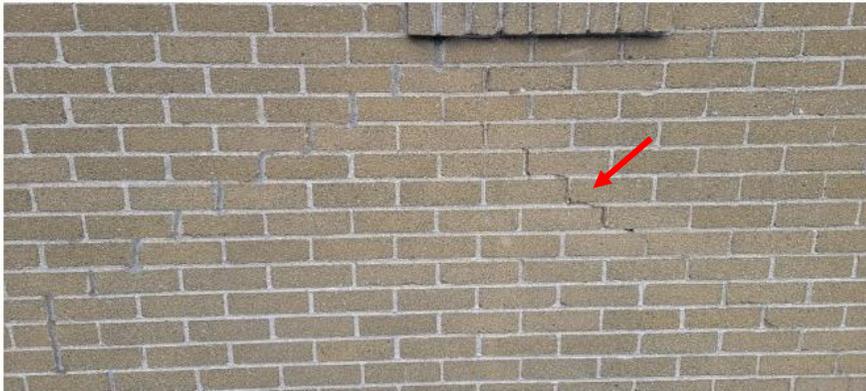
Fissure en escalier due au tassement différentiel des fondations.
